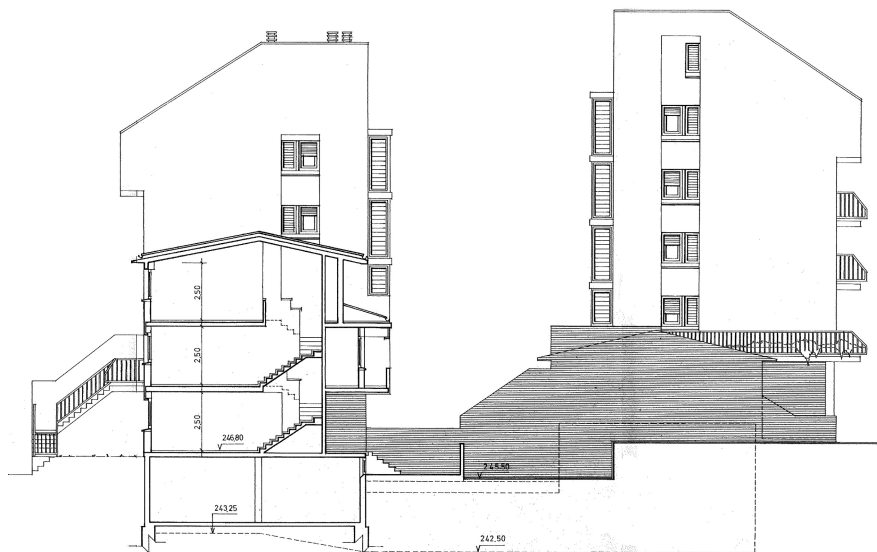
Sección transversal de la manzana que alberga el conjunto residencial Palma de Mallorca. Seccionada a través de las viviendas del tipo dúplex maclado con la proyección al fondo de la fachada de viviendas de apartamentos en altura. Pueden observarse las dimensiones de los jardines semiprivados delanteros, los jardines traseros y el encaje con las edificaciones medianeras vecinas.
